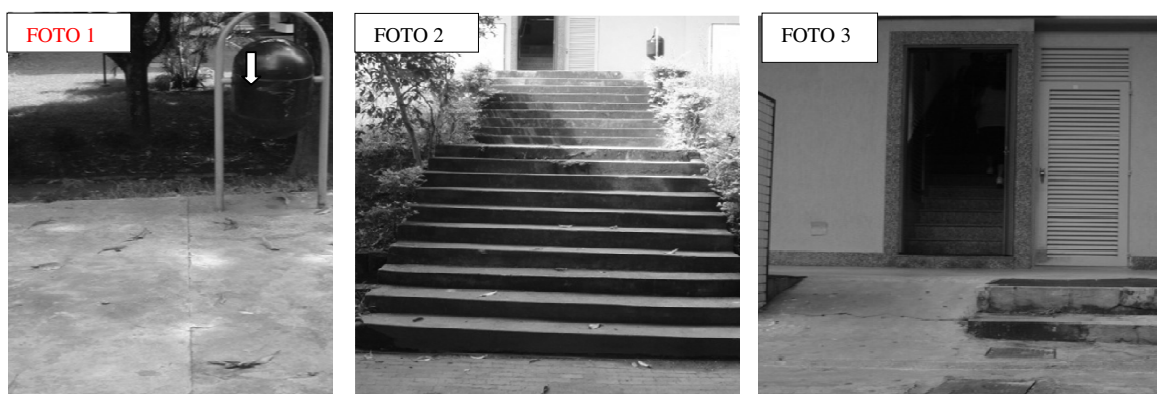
Foto 1, Lixeira; Foto 2, Escada 106NDE1; Foto 3, Rampa 106NDR4 e escada 106NDE2
